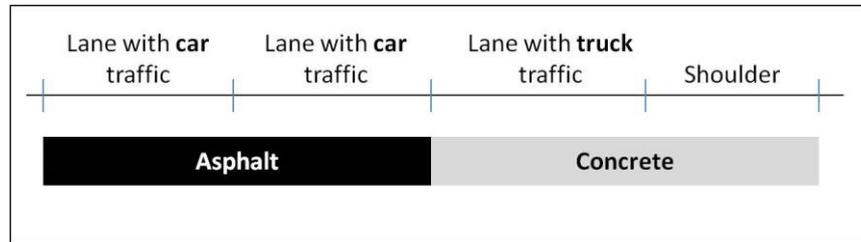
Pavimento de larga vida. Híbrido horizontal de asfalto y hormigón.
